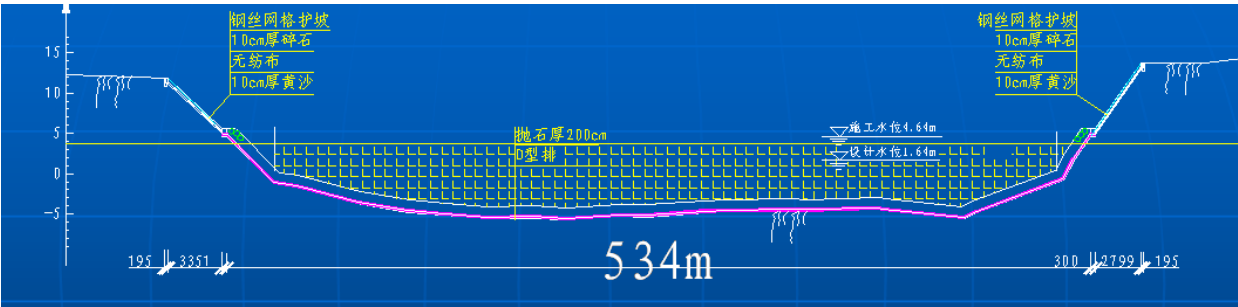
贵池北港 BK2 护底带水深剖面图
